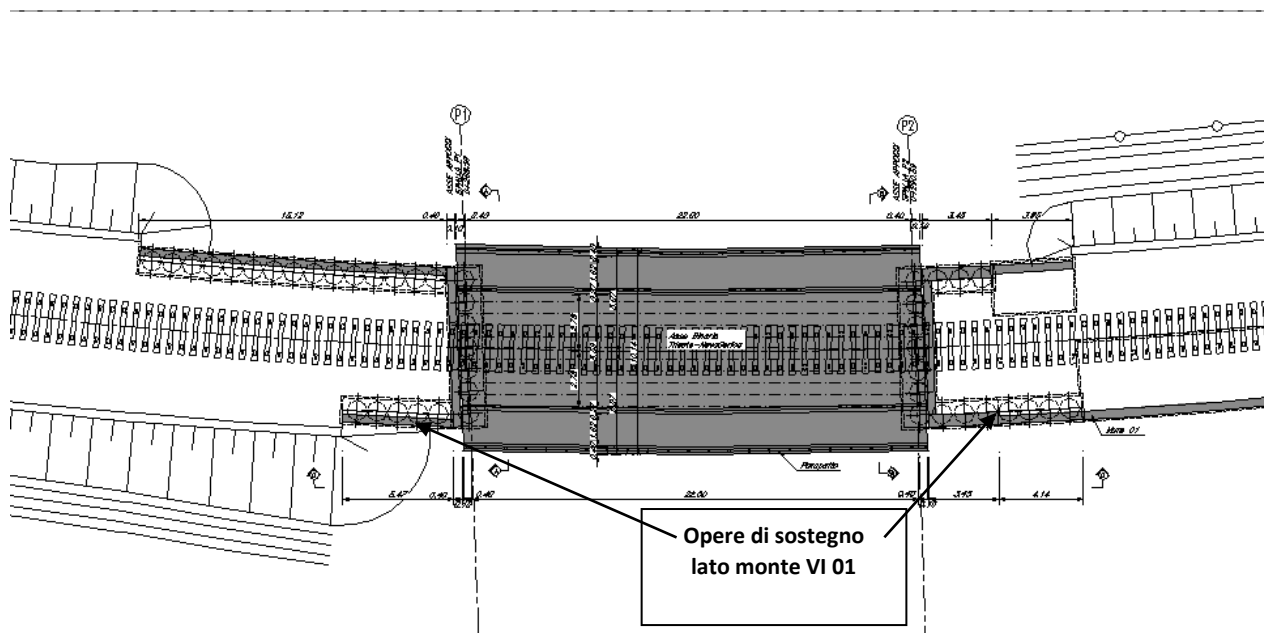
Planimetria con ubicazione dell'opera di sostegno lato monte.
